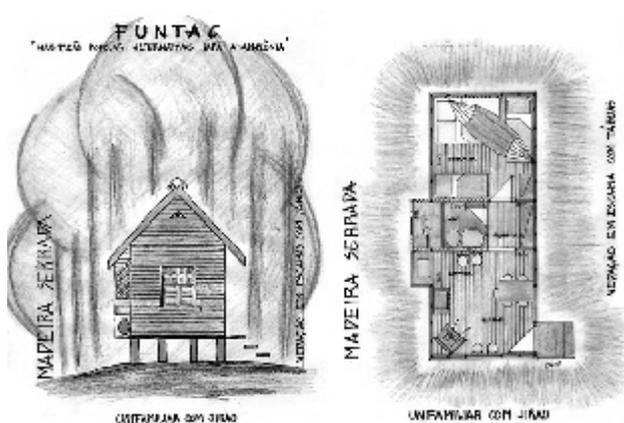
Madeira serrada para área urbana – fachada e planta baixa
